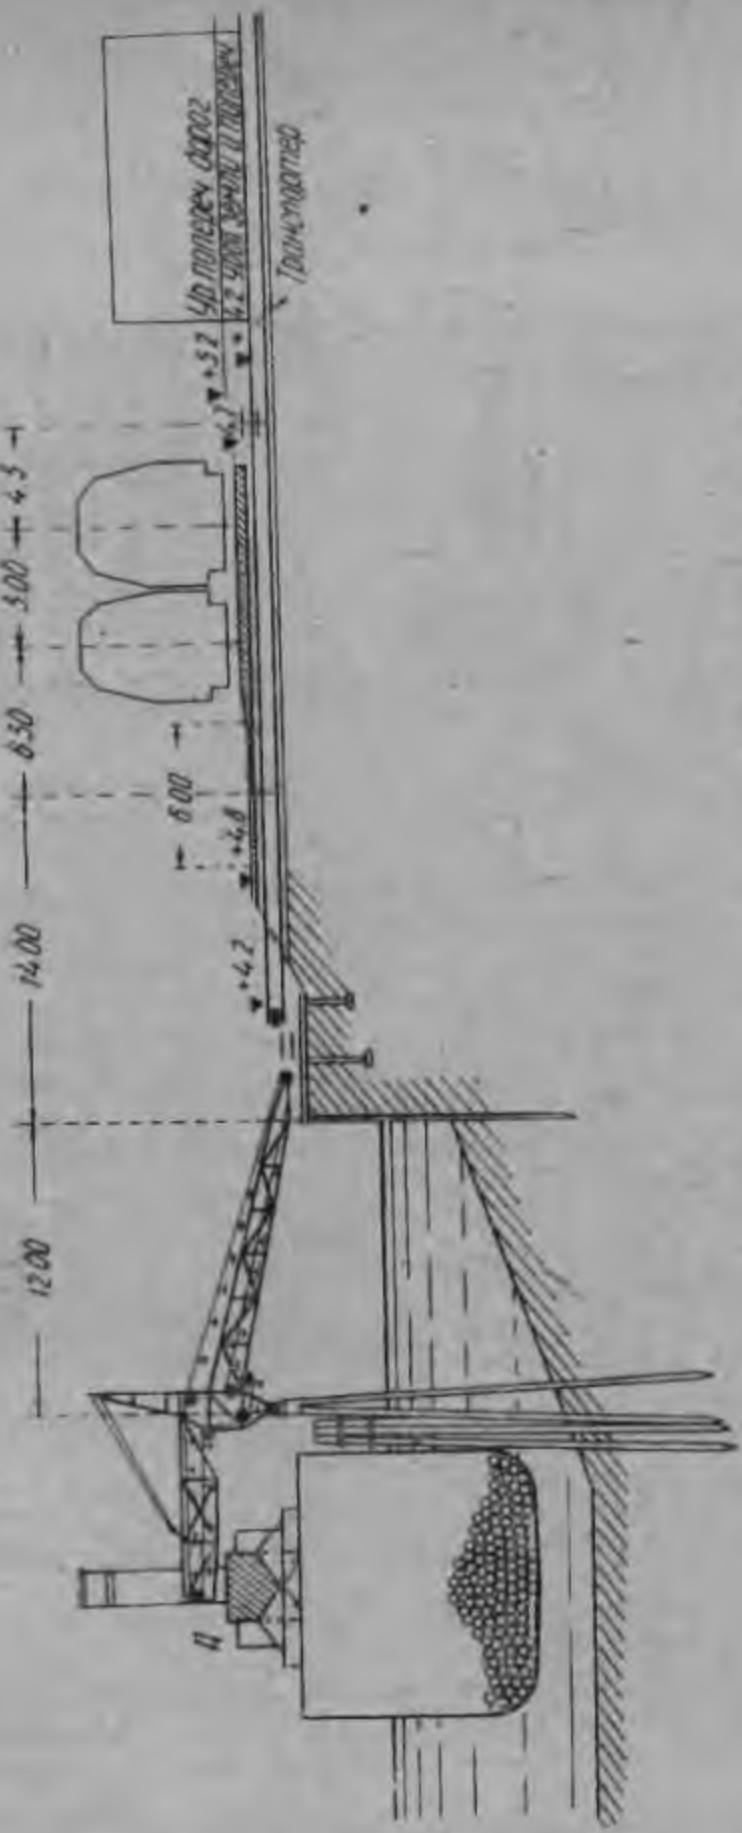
Схема погрузки круглого леса с берега на судно генеральным коппером.
